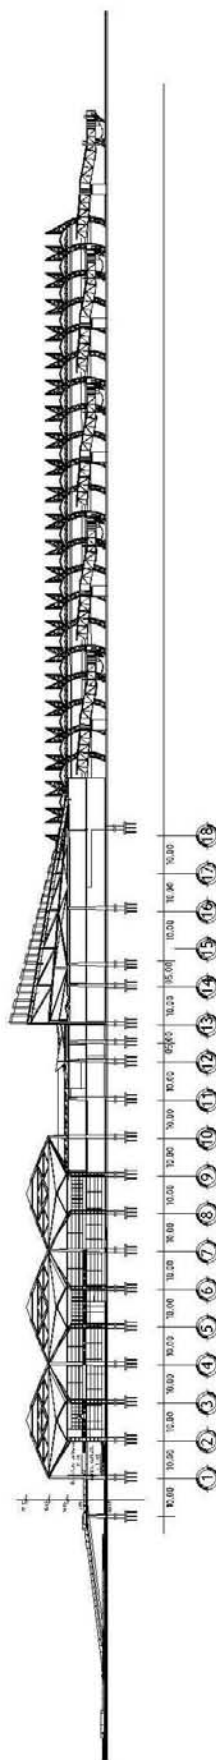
Potongan Terminal zona darat Alternatif 2
